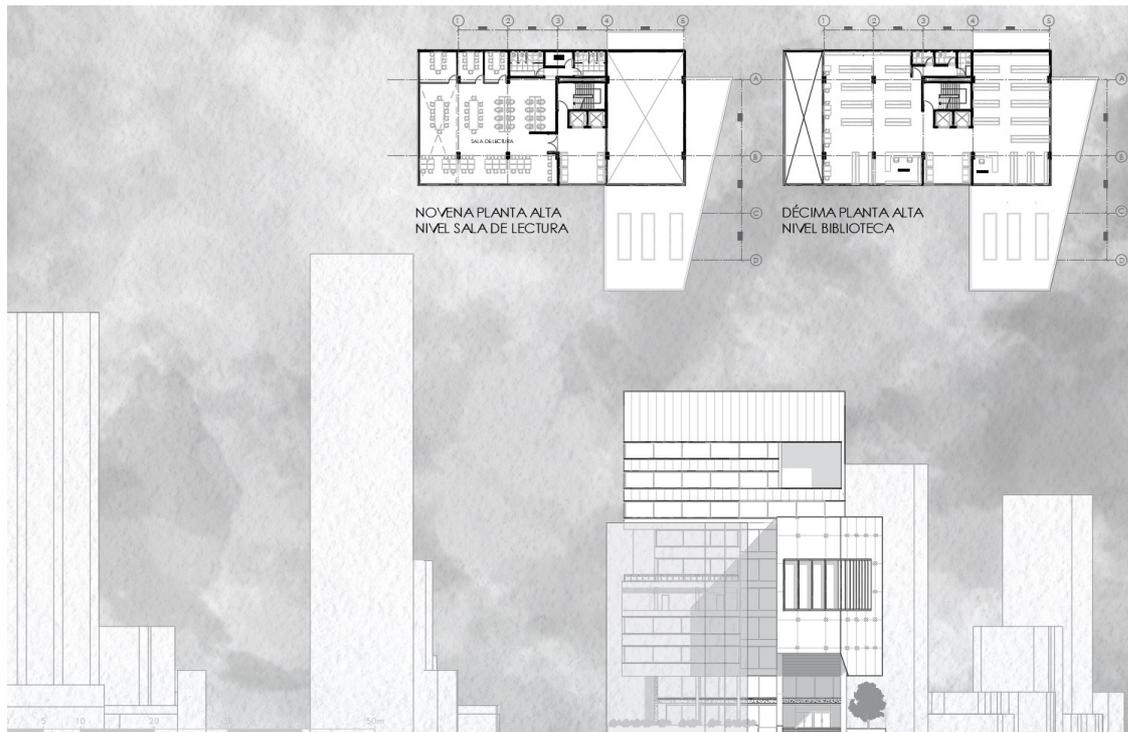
, Planta 9-10, Fachada av. Patria. Elaboración propia
